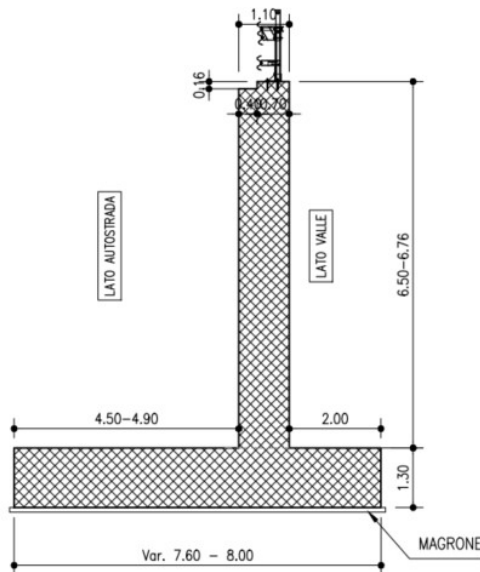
Sezione trasversale del muro andatore carreggiata lato Nord
